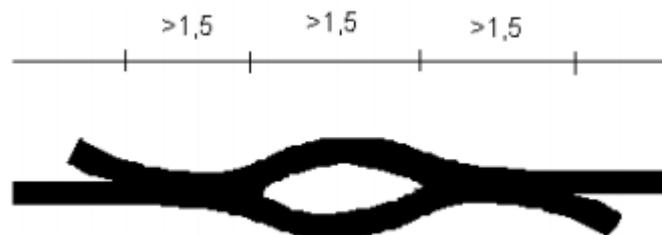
Detalle de soldadura por fusión o cuña caliente.
